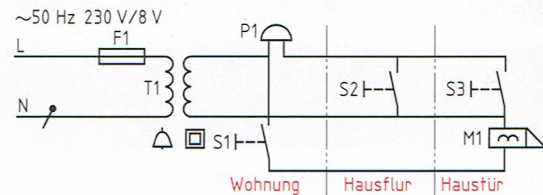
Stromlaufplan einer Klingel- und Türöffneranlage für ein Einfamilienhaus
